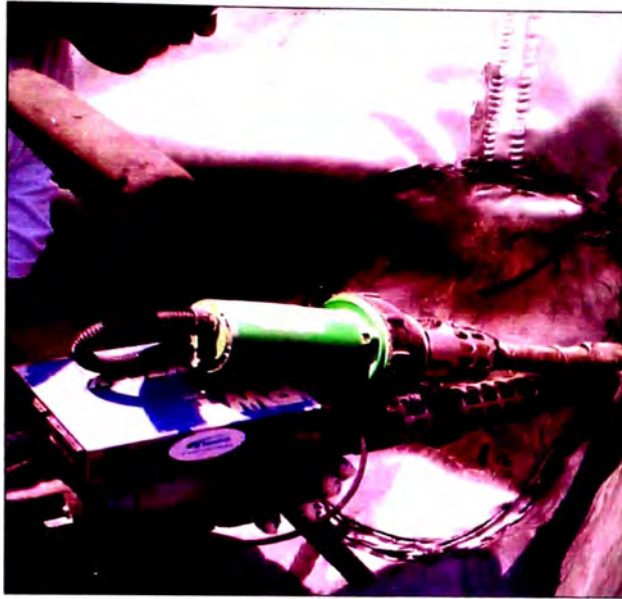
Colocación de alambre de cobre con soldadura de extrusión, para prueba de chispa eléctrica
